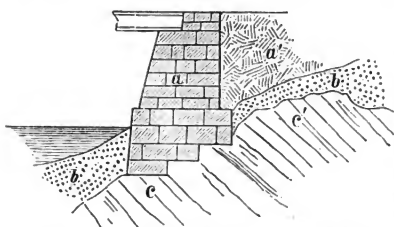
Fundament eines Brückenpfeilers auf ungleichem Untergrund.
